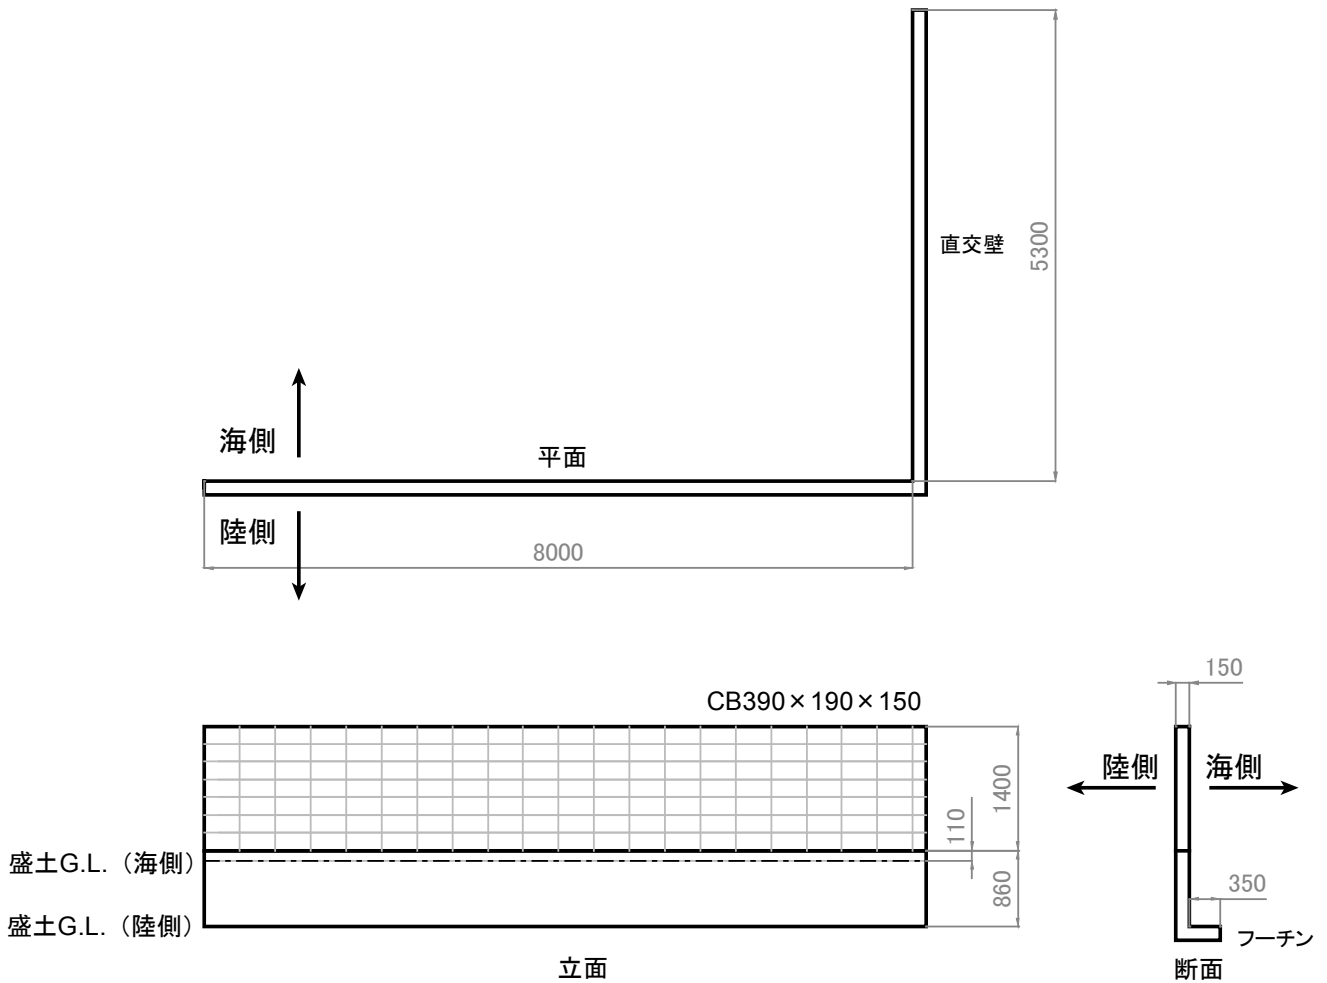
(株)SK 商店敷地の CB 塀 平面・立面・断面図 (単位: mm)
